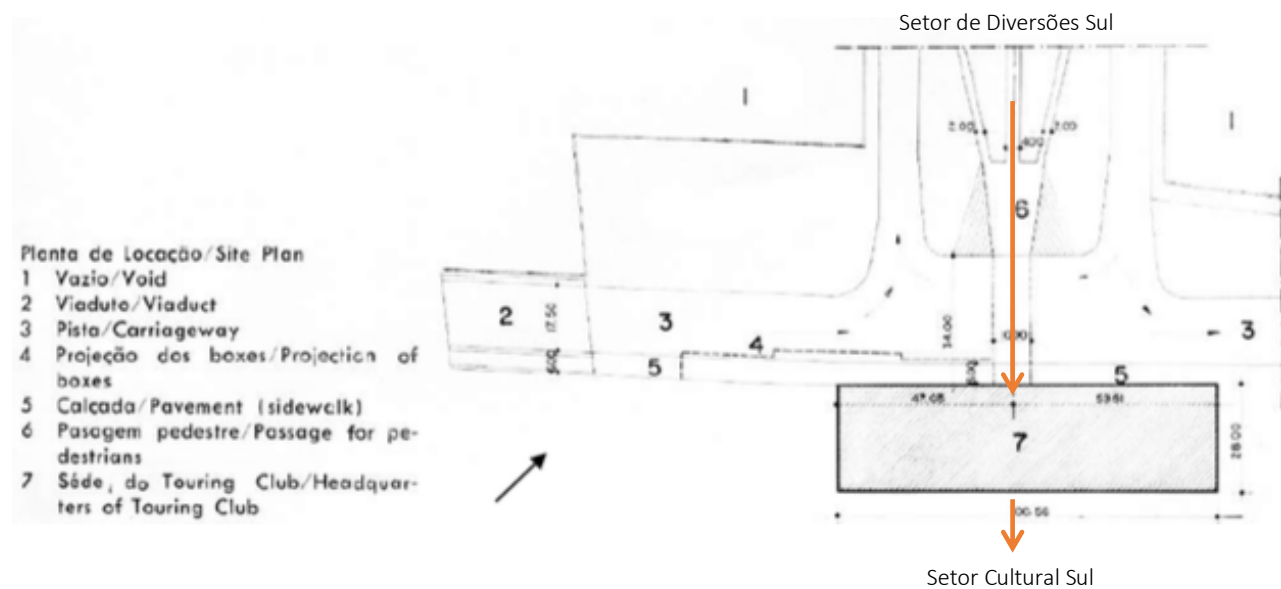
Planta de implantação da primeira proposta para o Touring Clube do Brasil, Brasília. Crédito: Revista Módulo out/1962.
